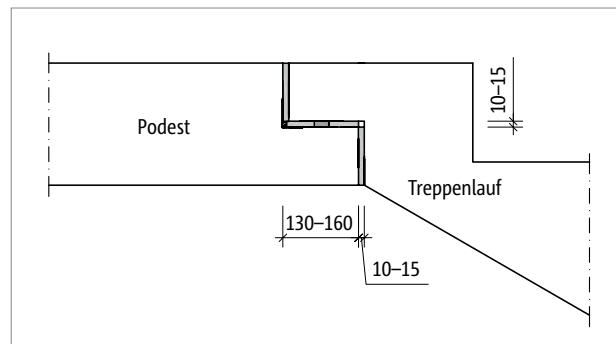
Schöck Tronsole® Typ F: Ausführungsvariante bündiger Treppenanschluss
